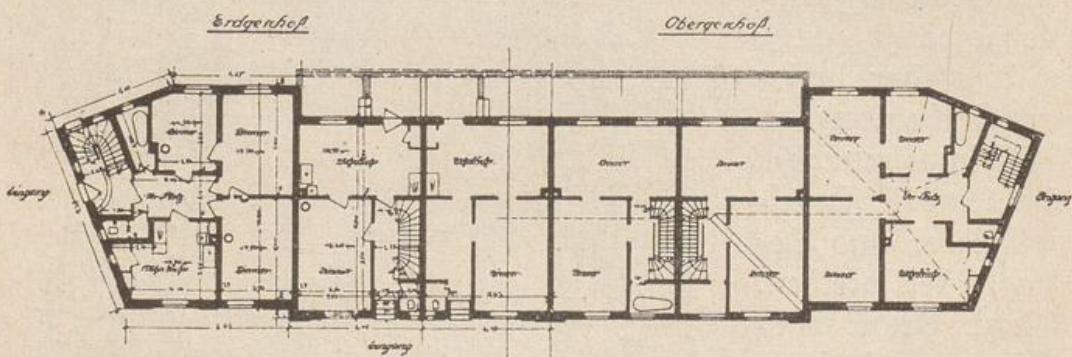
Gebäudegruppe mit Ein- und Zweifamilienhäusern.
